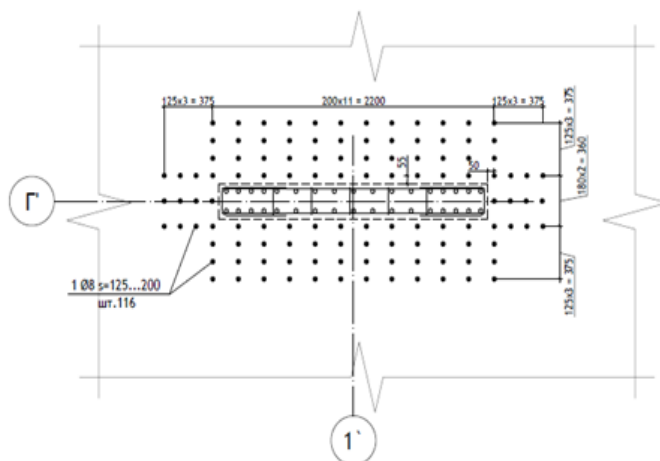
Армування опорної зони плити вертикальною поперечною стержньовою арматурою
